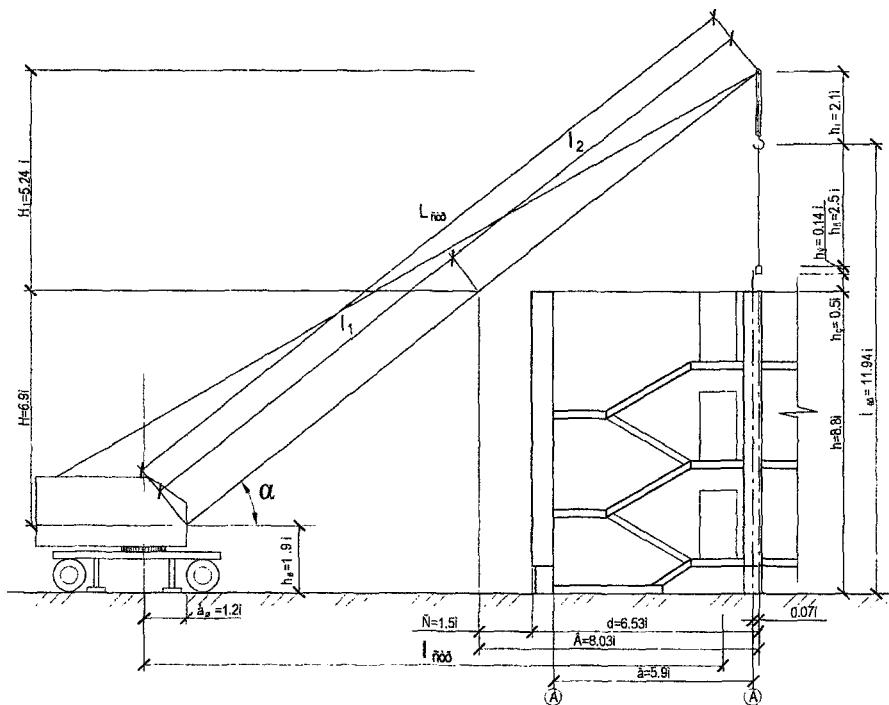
Схема к определению рабочих параметров крана при укладке железобетонной перемычки ПР-4 над дверным проемом
